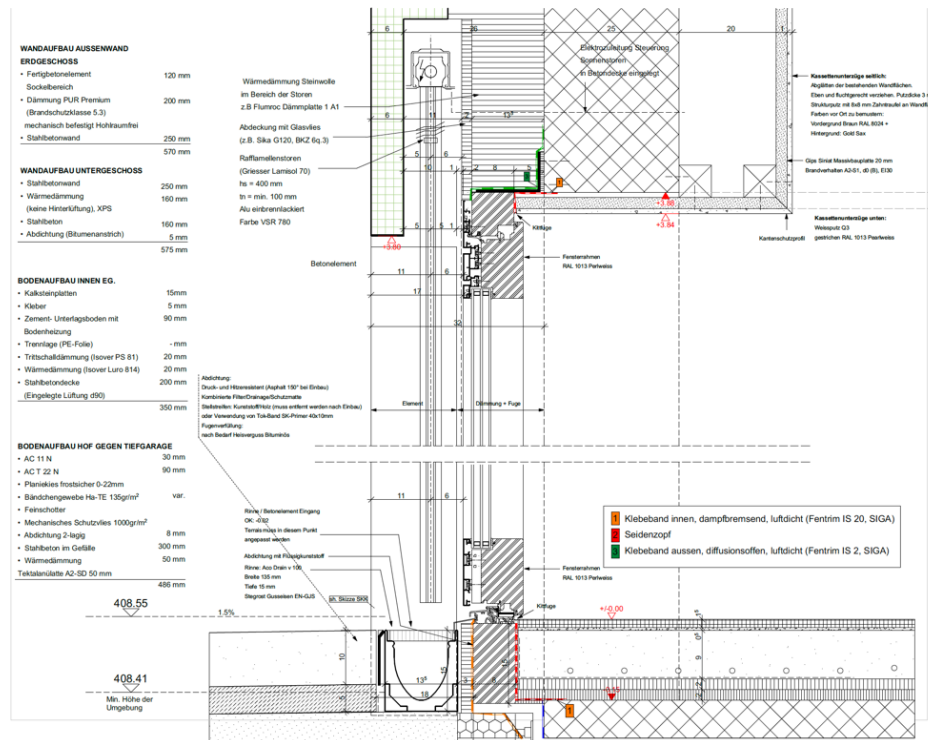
Wandaufbau Aussenwand Erdgeschoss
